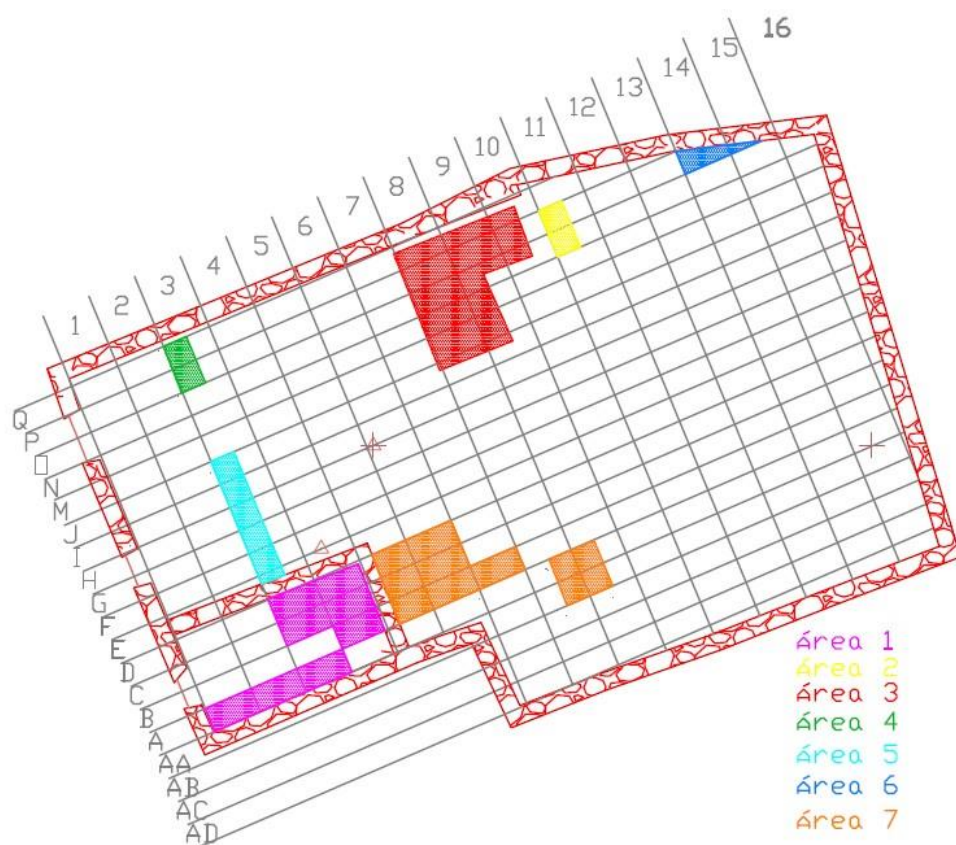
Planta destacando as áreas intervencionadas. (PINTO, 2005, Anexos IV)
